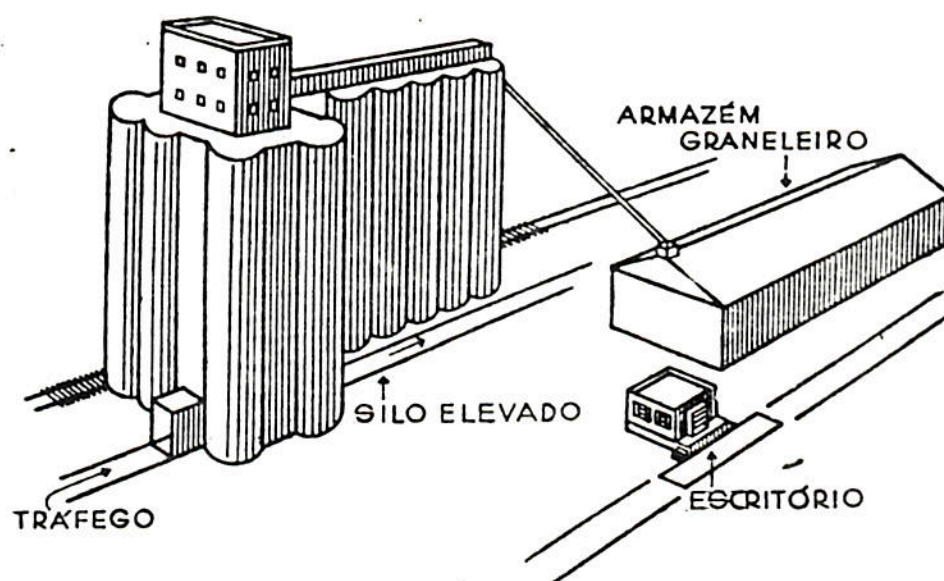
Silo horizontal conjugado a um silo vertical (PUZZI, 1977).
